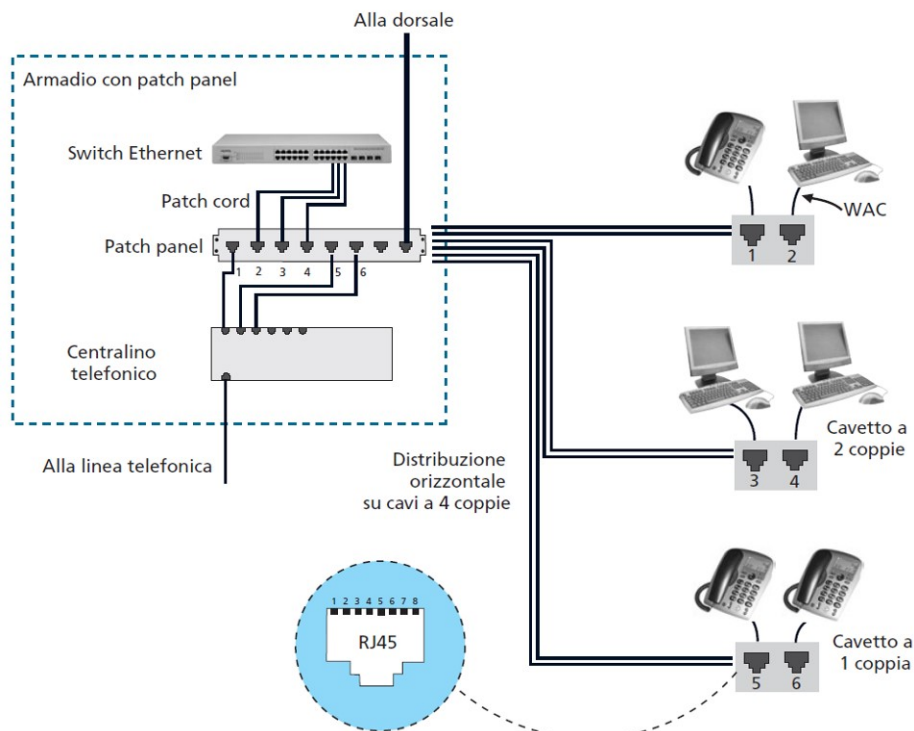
Schema di principio dell'impianto fonia/dati con modalità "cablaggio strutturato"
